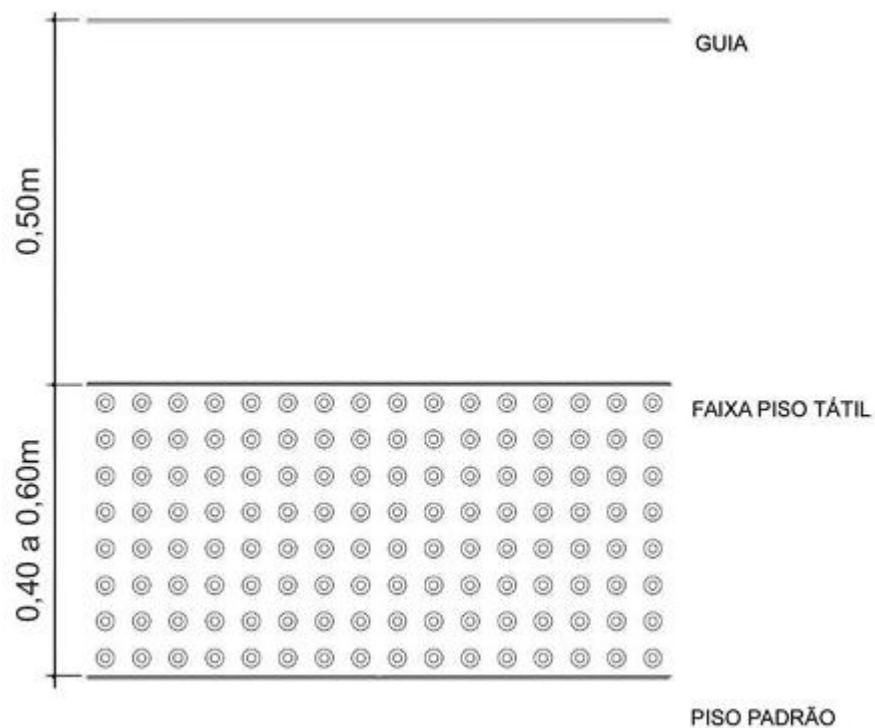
Planta - Piso tátil de alerta aplicado em plataformas.
